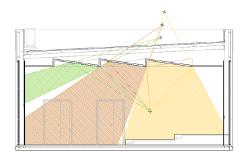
Estudio acústico – geometría del techo (Sección 1) [3].
